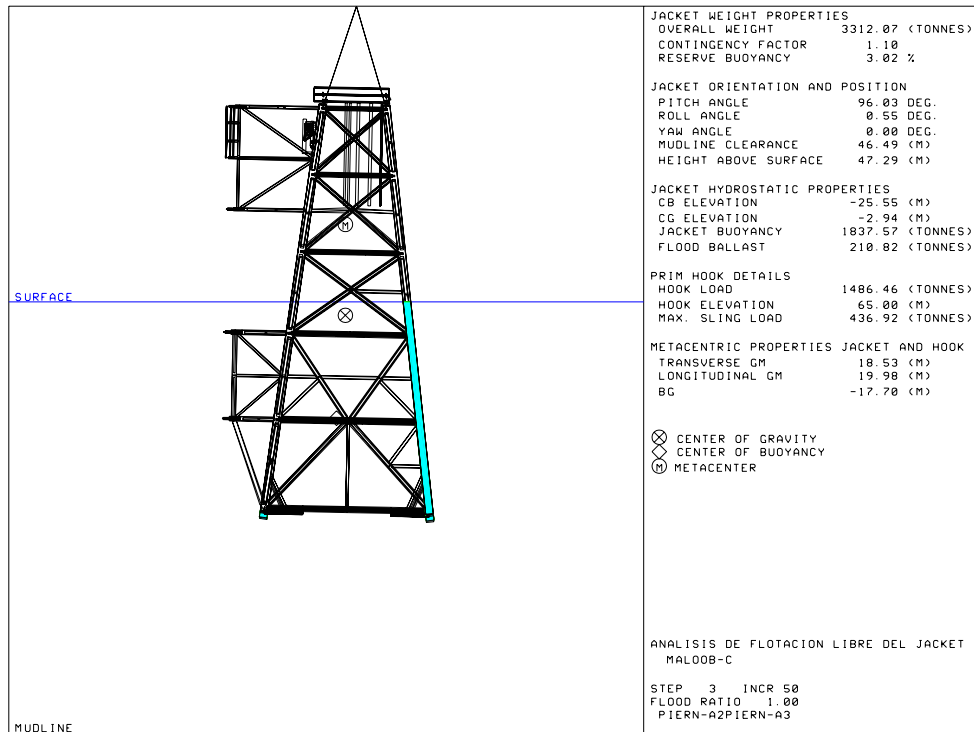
Posición de la estructura para una elevación de 65.00 m.
